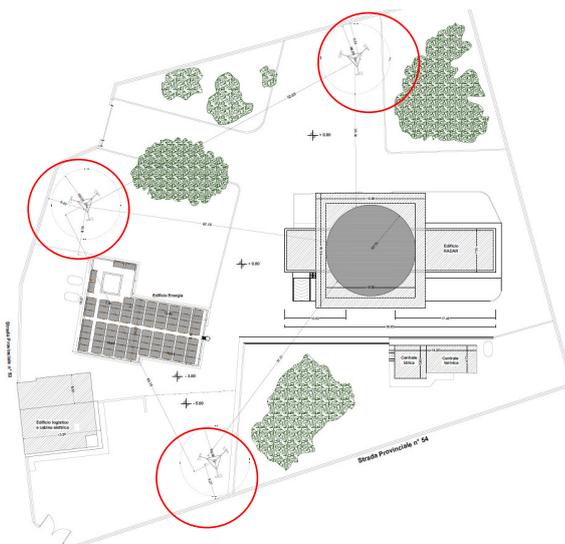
Planimetria di progetto con individuazione delle pale mini-eoliche (in rosso)
